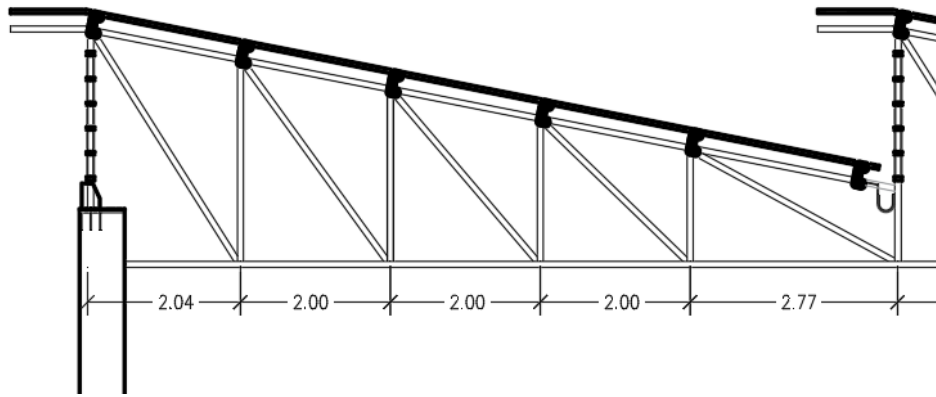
Diseño de Tijera (T-100) en cubierta.
